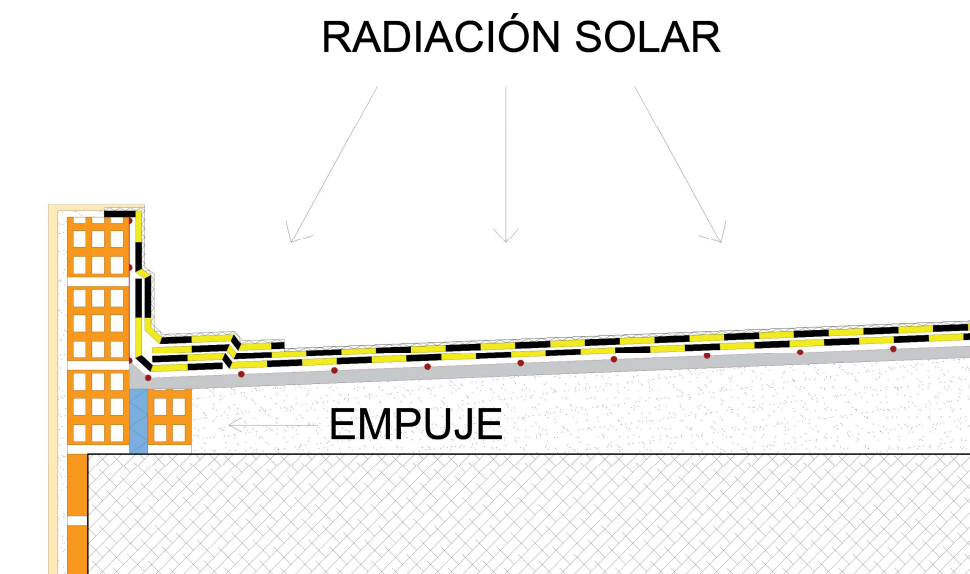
Detalle empuje cubierta. Fuente: Elaboración propia.
